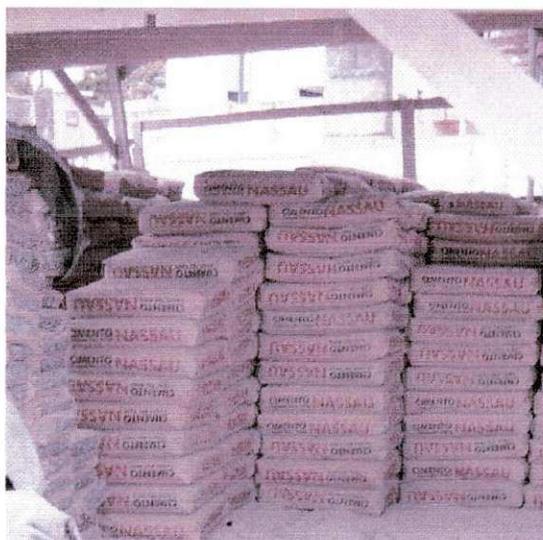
Disposição de sacos de cimento Portland em canteiro de obras.
